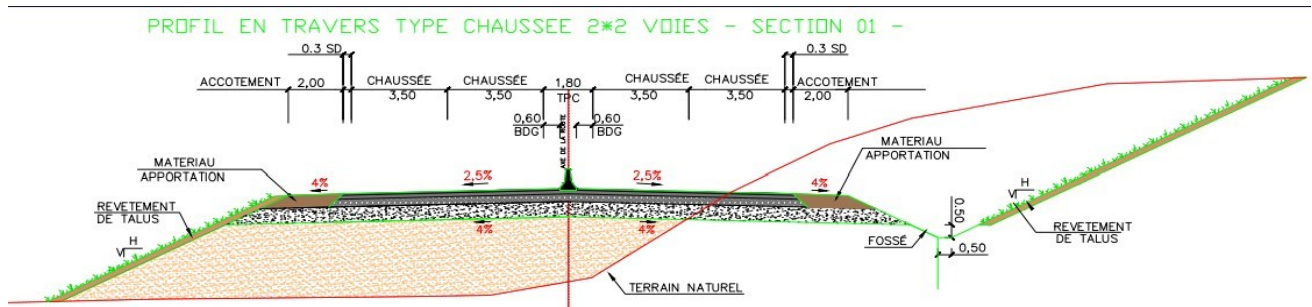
Profil en travers type chaussée 2x2-section 01.
